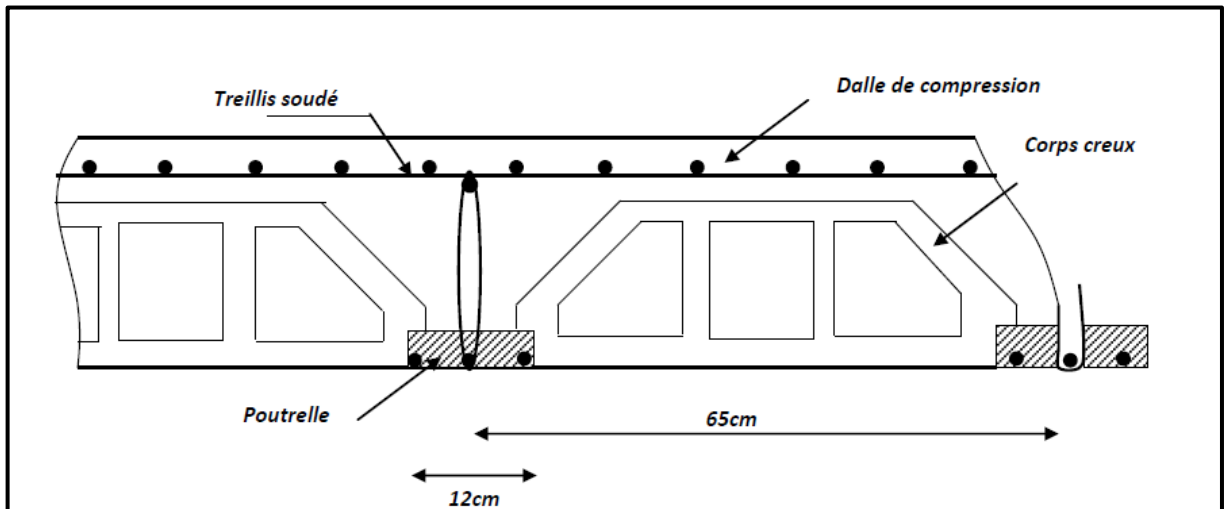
Coupe transversale d'un plancher en corps creux (16+4)
